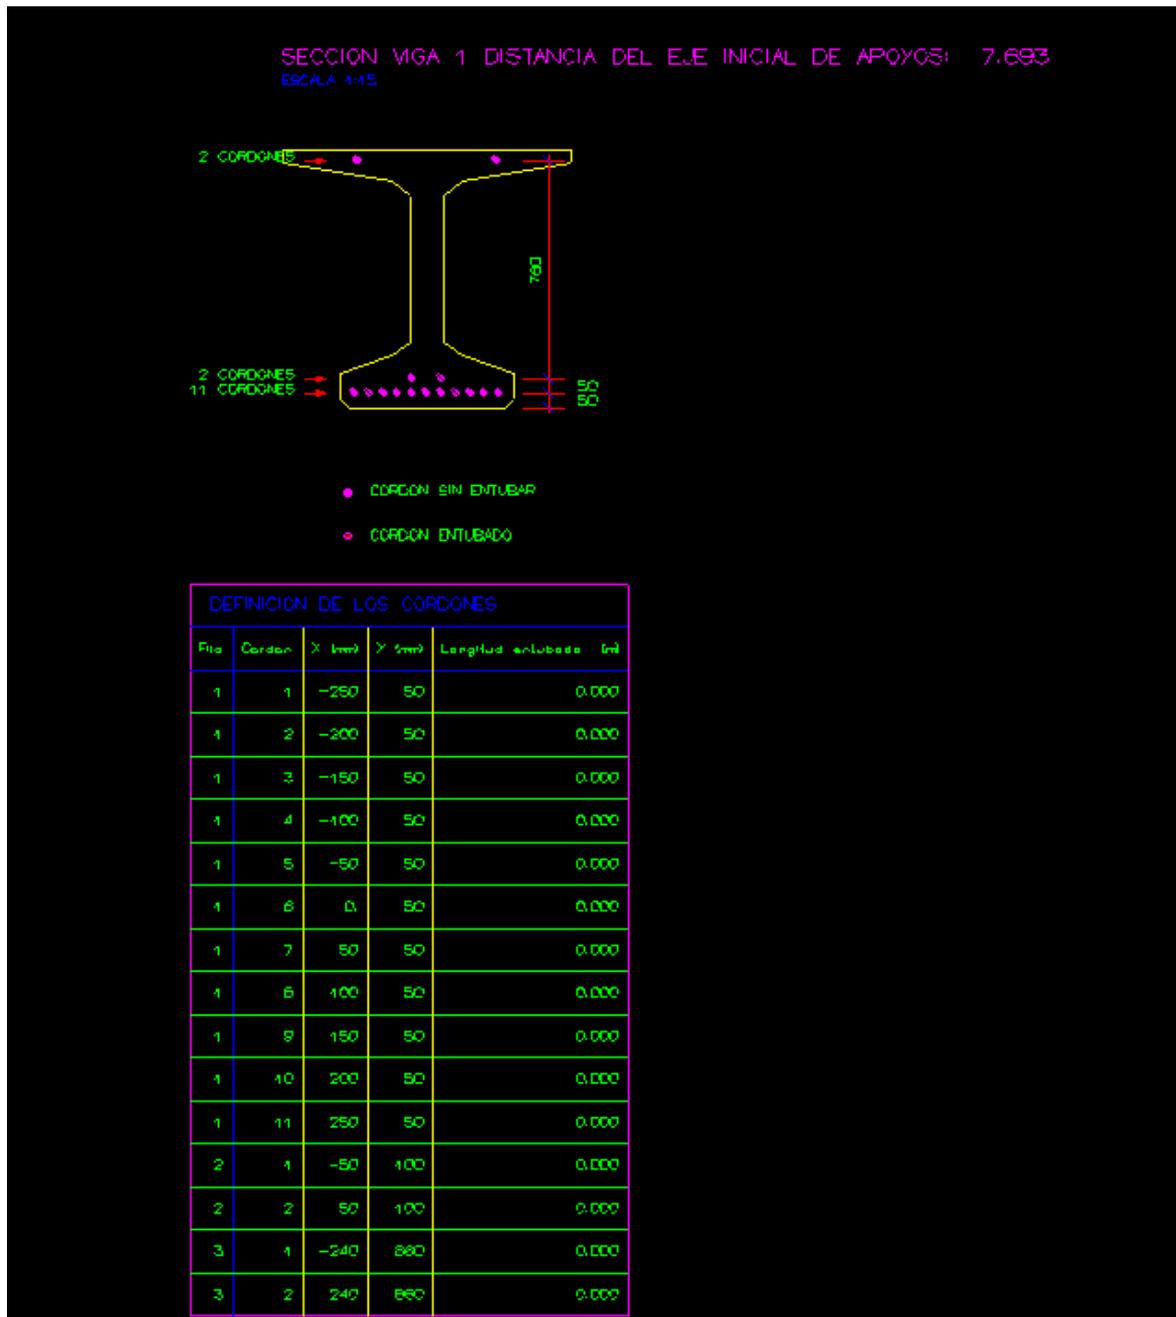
Figura *Sección de la viga
